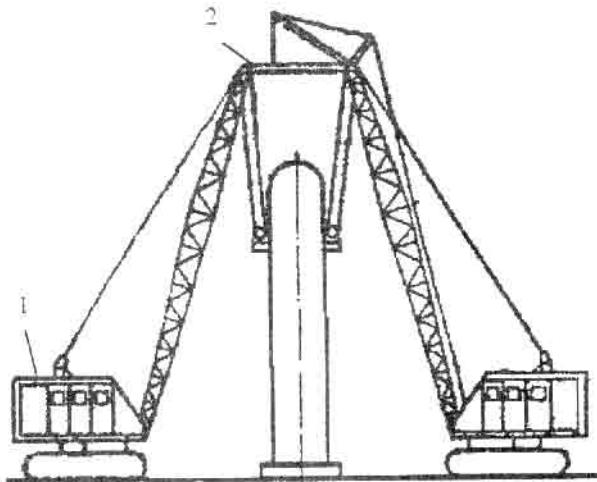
Схема кранов со стрелами, соединенными ригелем:
